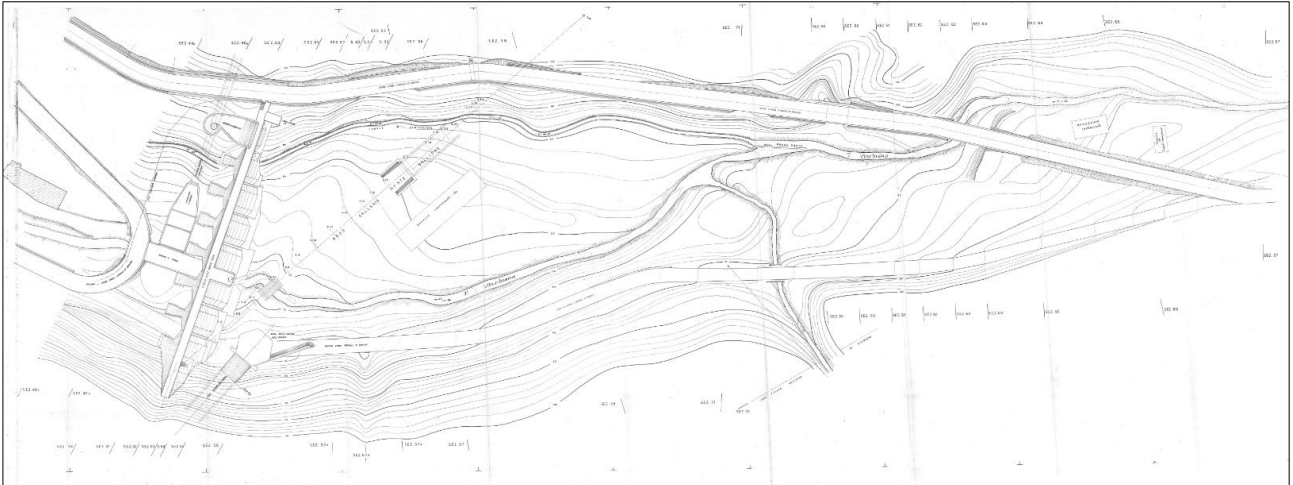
Planimetria serbatoi della Vinchiana 1949 - Archivio Enel
